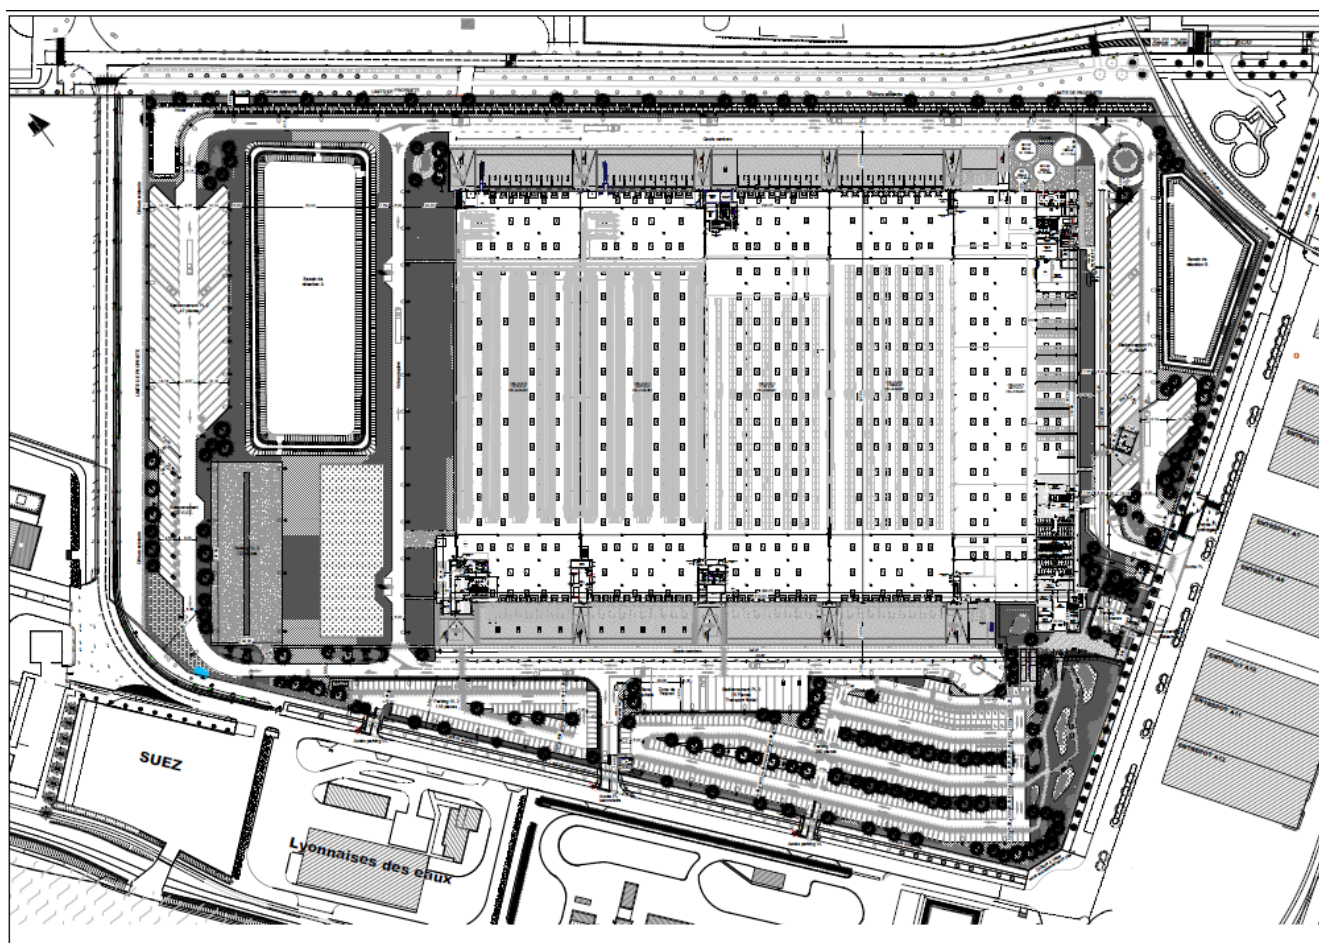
Plan du projet (Source : Plan de plantation - IKEA)
